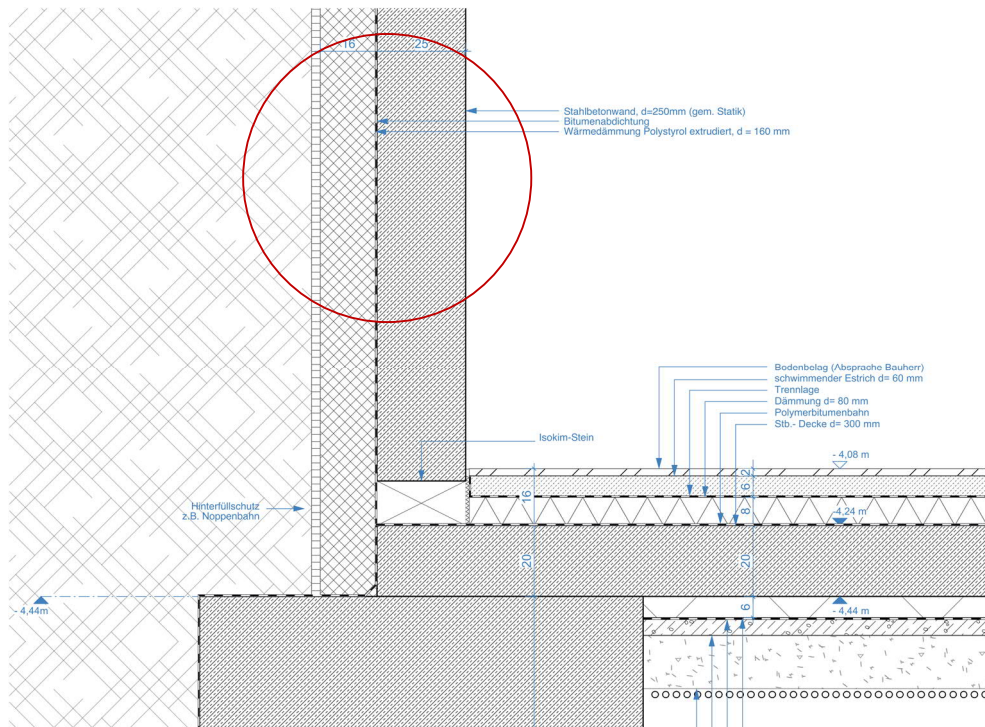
Leitdetail Sockelanschluss / erdberührte Außenwand_ursprüngliche Planung
